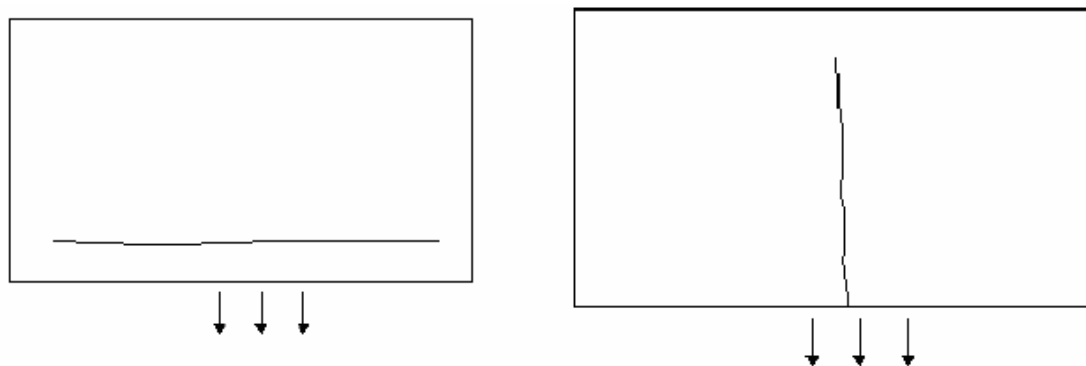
Fisura en muros divisorios por luz excesiva en losa
